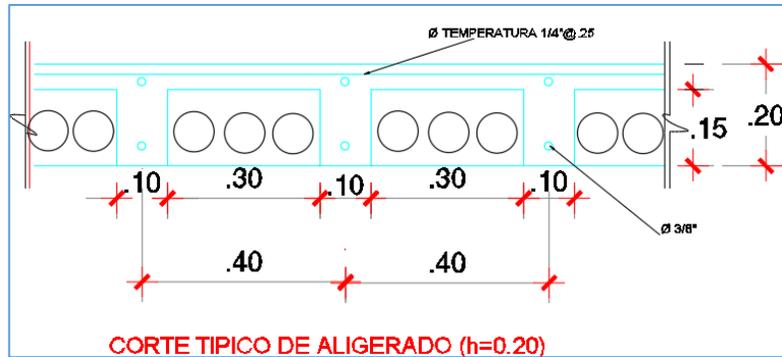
Detalle típico en 2D de la losa aligerada con los bloques de concreto ligero
